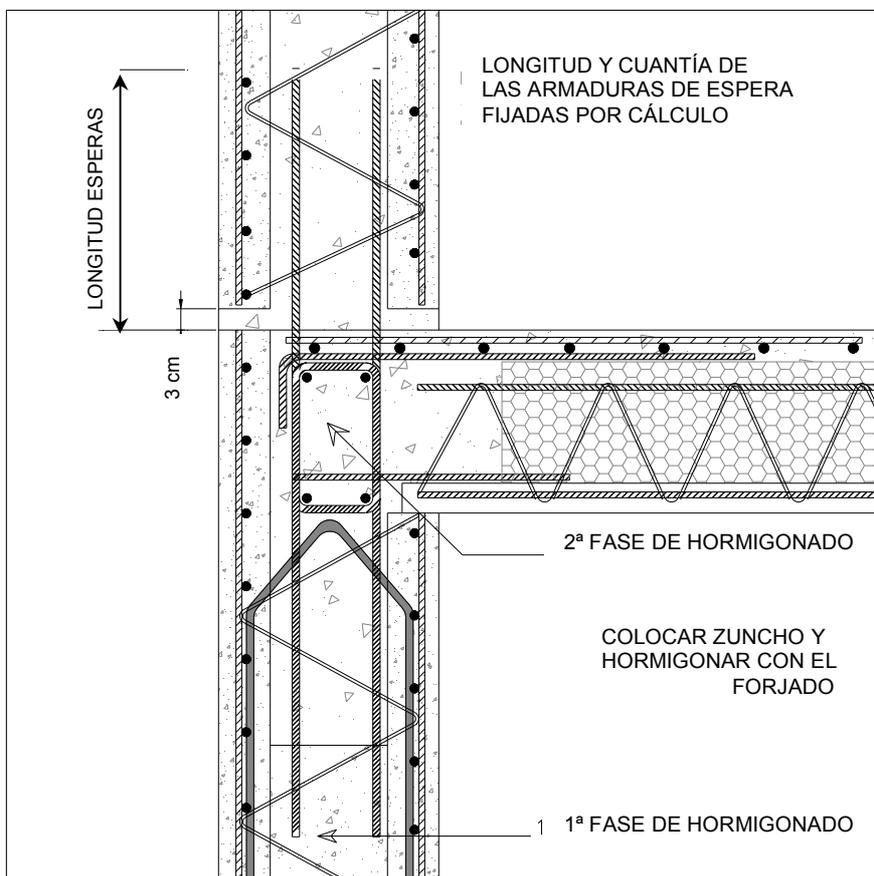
DETALLE DE UNIÓN CON MURO SUPERIOR – APOYO INDIRECTO
